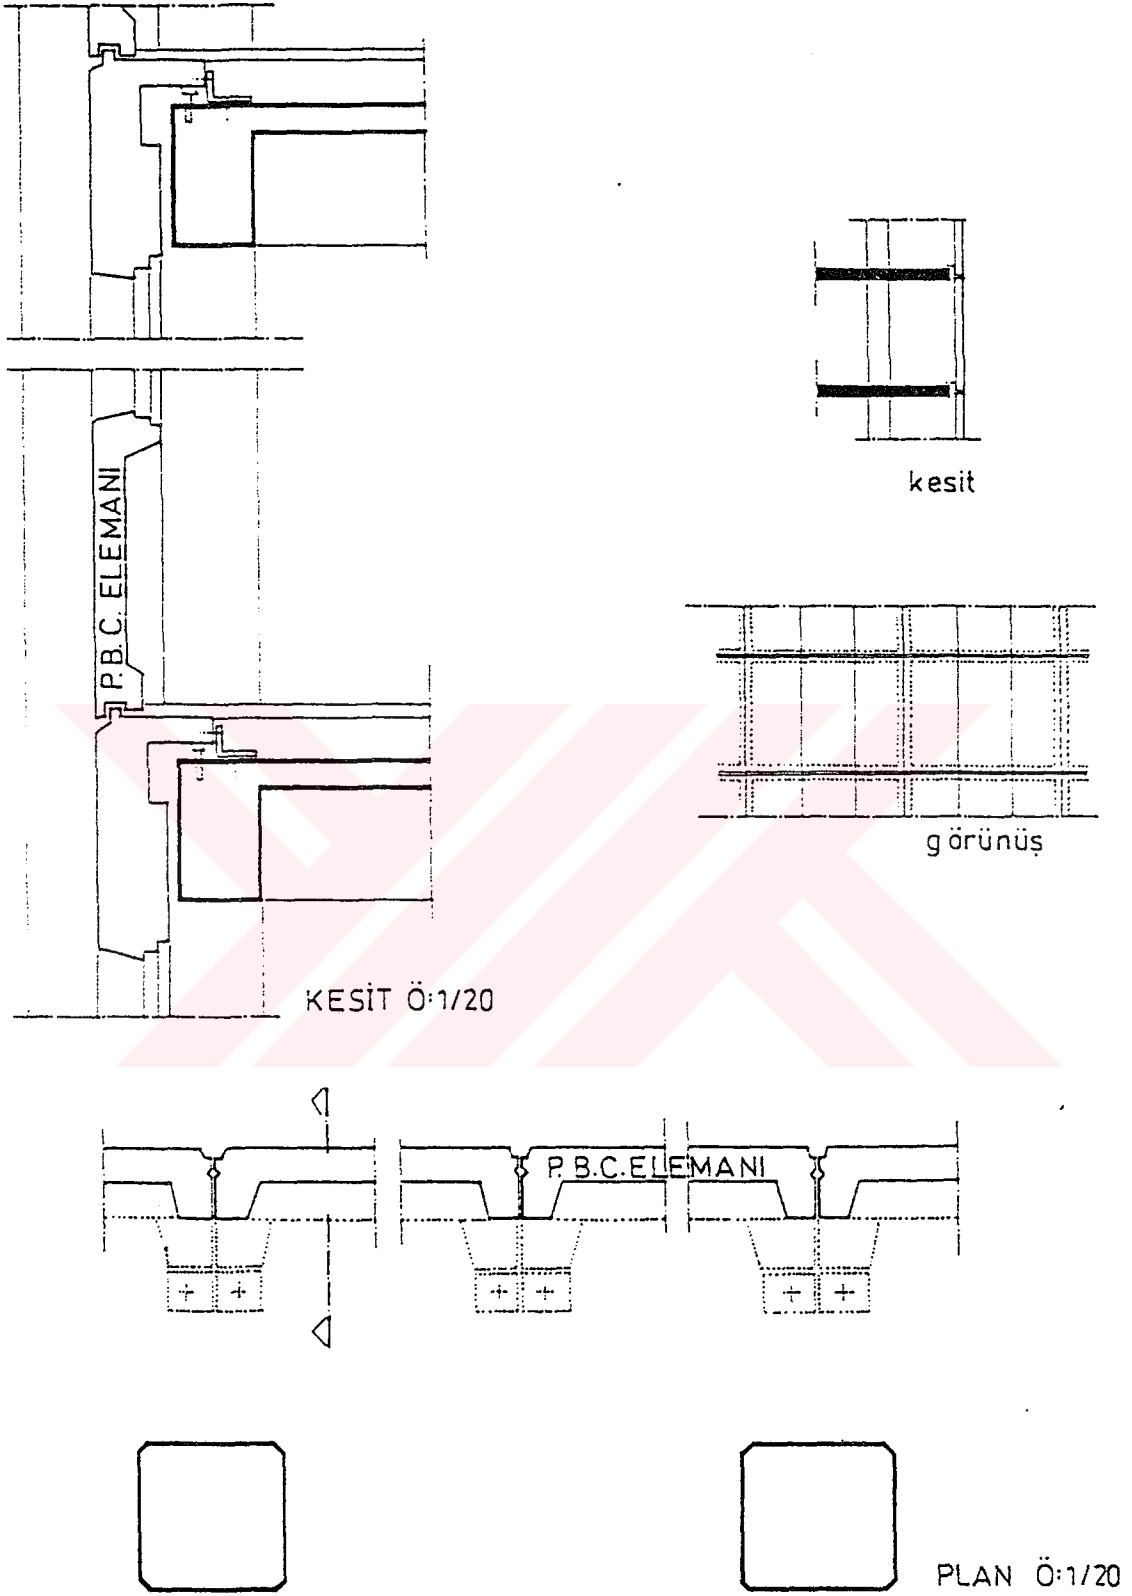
Kirişlerin Önüne, Kolonların Arasına Getirilmiş
